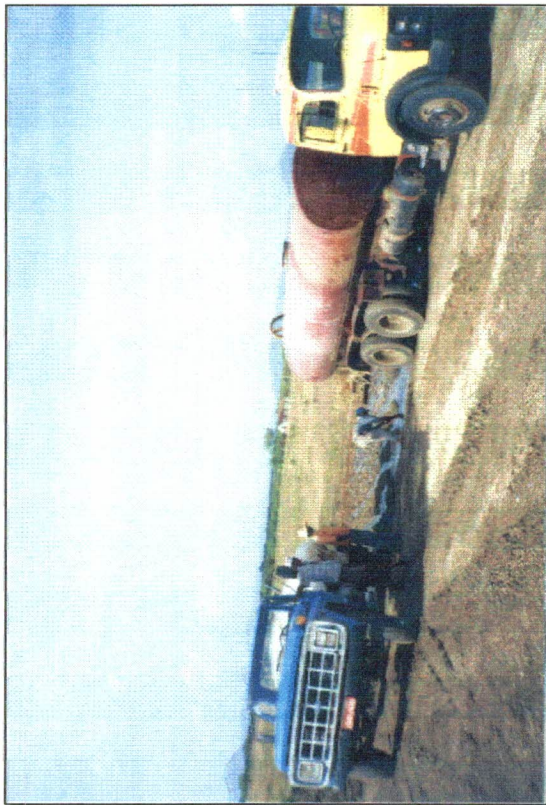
Umedecimento da jazida JT-20A.
